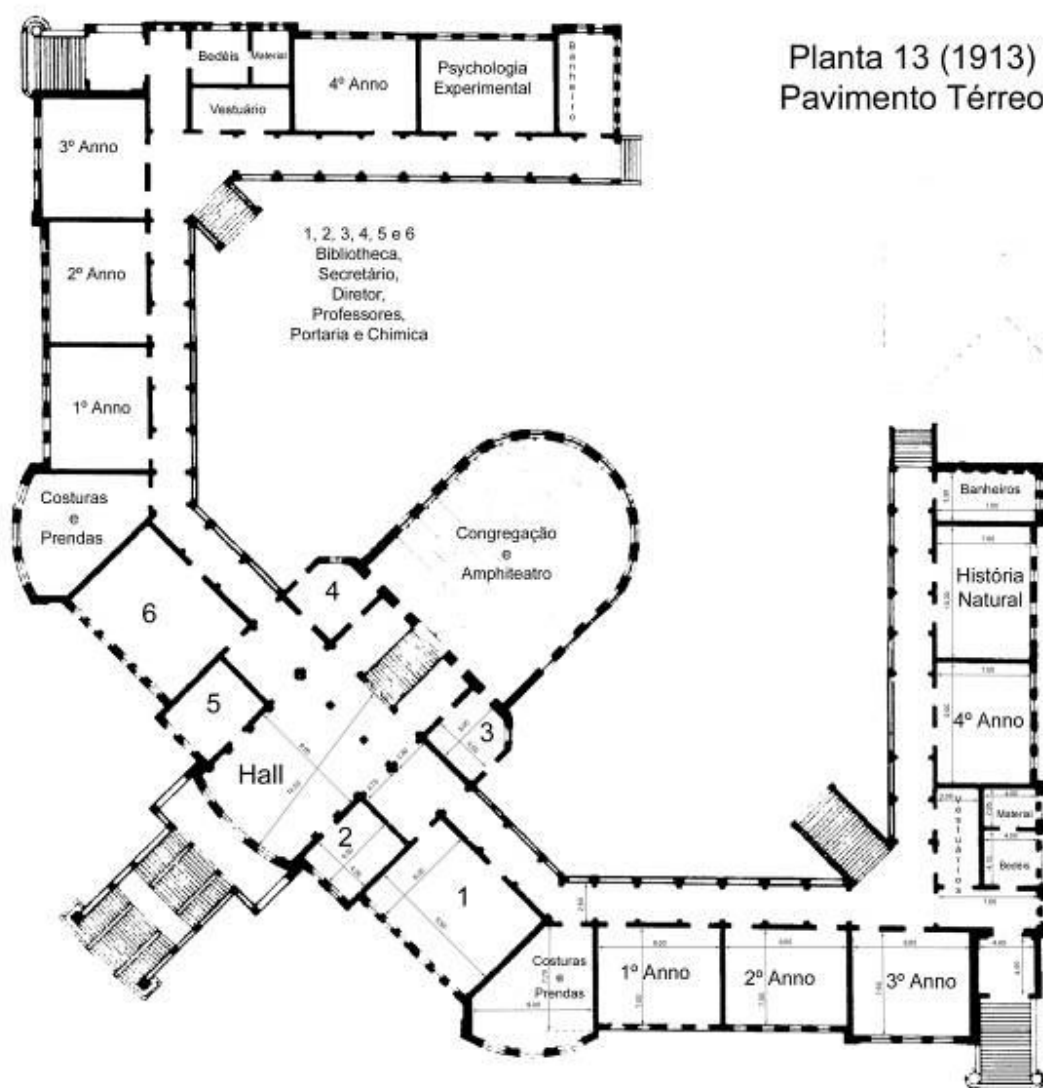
Planta da escola normal de São Carlos, pavimento térreo.
